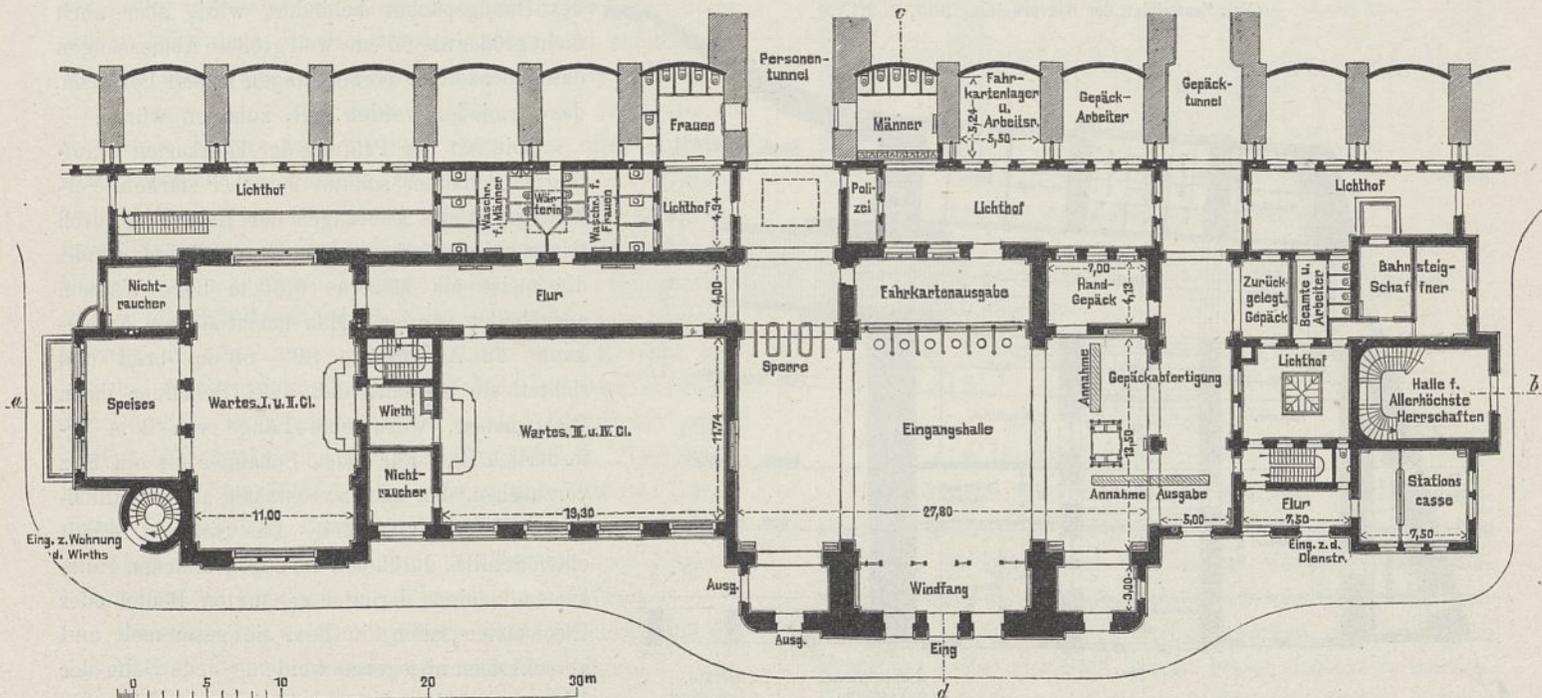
Eisenbahneempfangsgebäude in Koblenz. Erdgeschoß.
